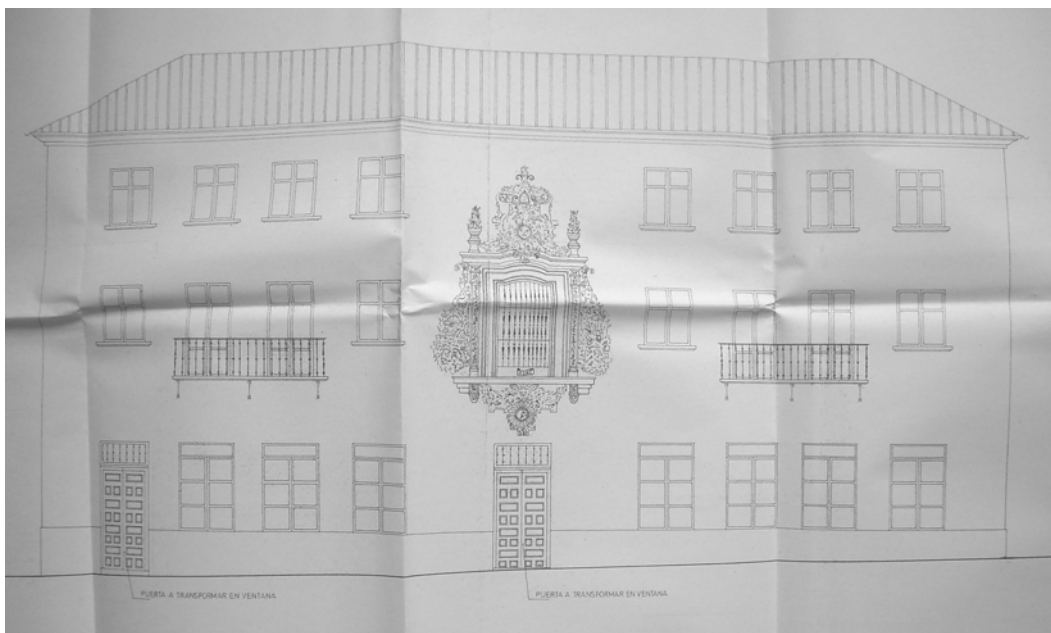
Ampliación de Derecho: reforma de la fachada C/ Libreros, por J. E. Díez Sánchez, febrero, 1978.
